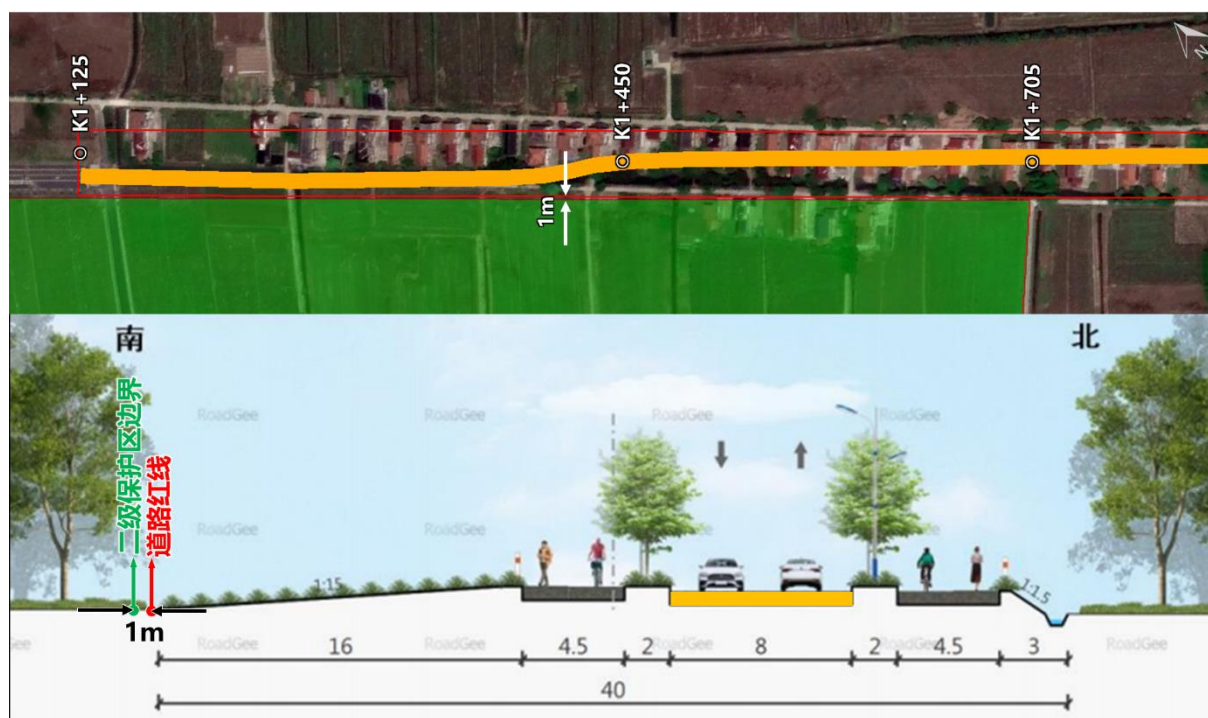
项目与二级保护区陆域边界的位置关系平面、横断面示意图
